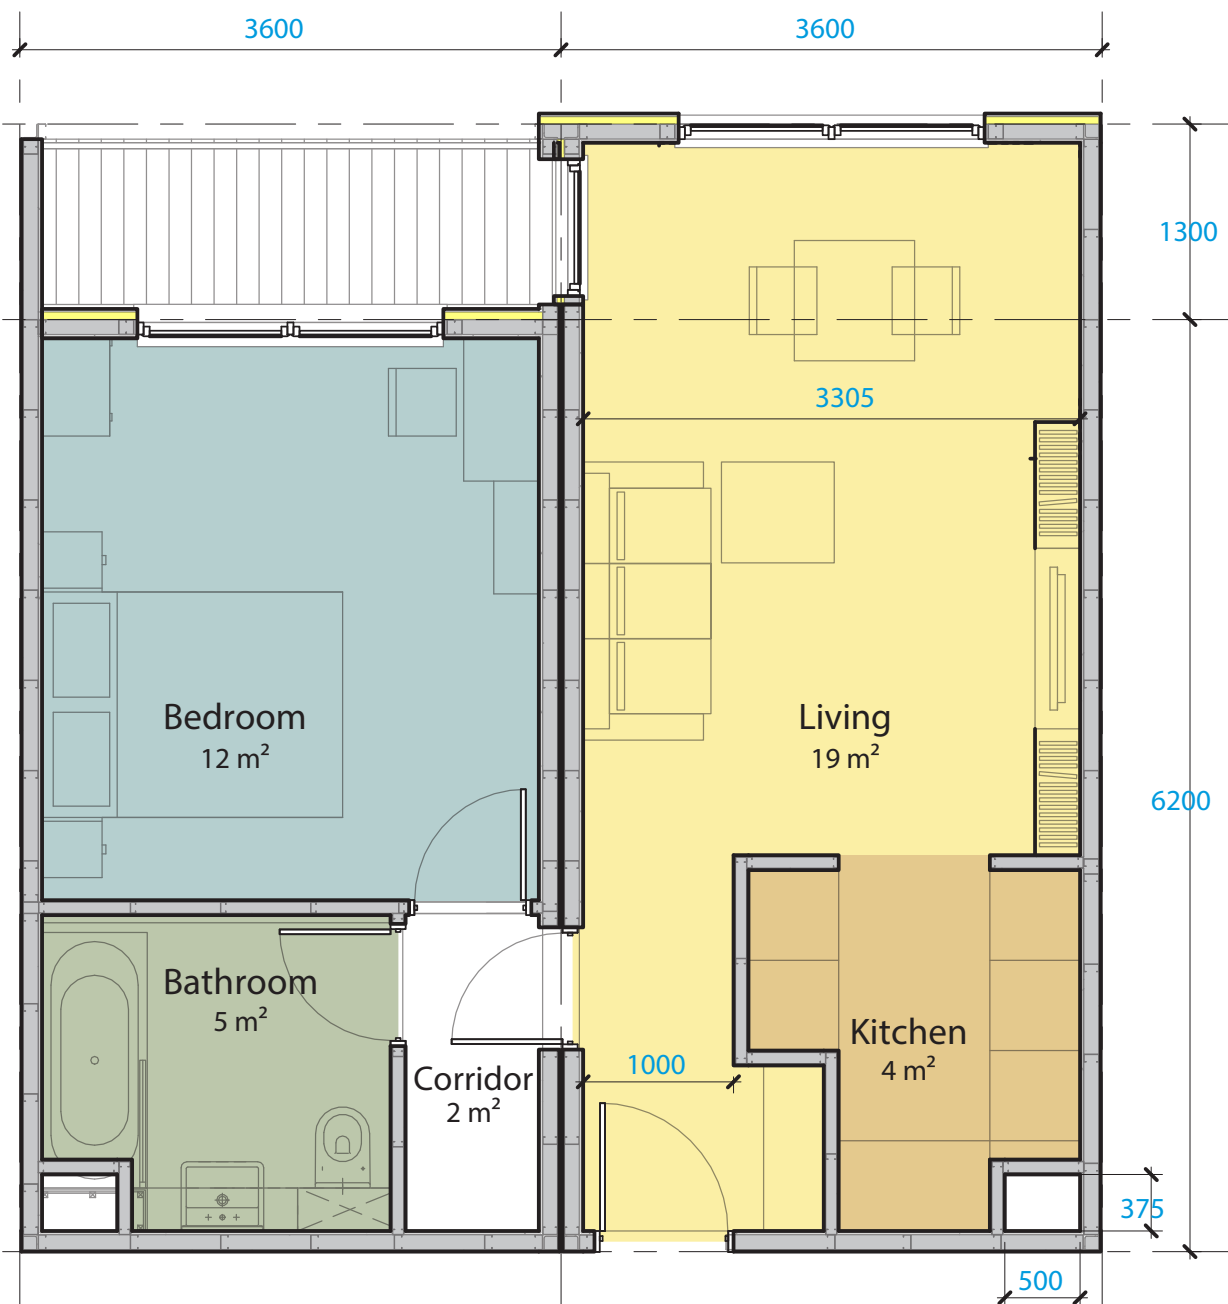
Квартира з 1 спальнею _ План поверху / Масштаб 1:100
